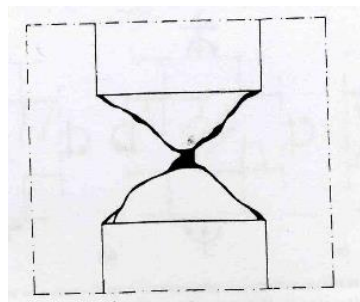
Fissures de cisaillement de forme X dans les poutres courtes (linteaux) qui relient des murs de cisaillement [2].
